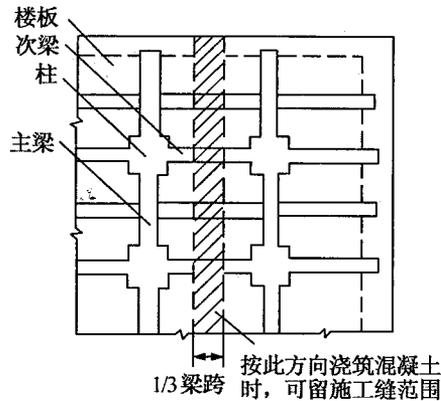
浇筑有主次梁楼板的施工缝位置图
